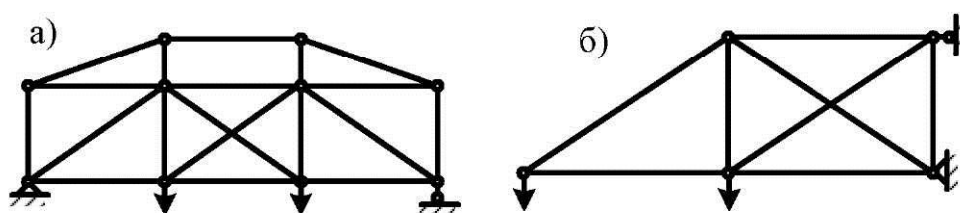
Расчетные схемы ферм: а) балочная ферма,
